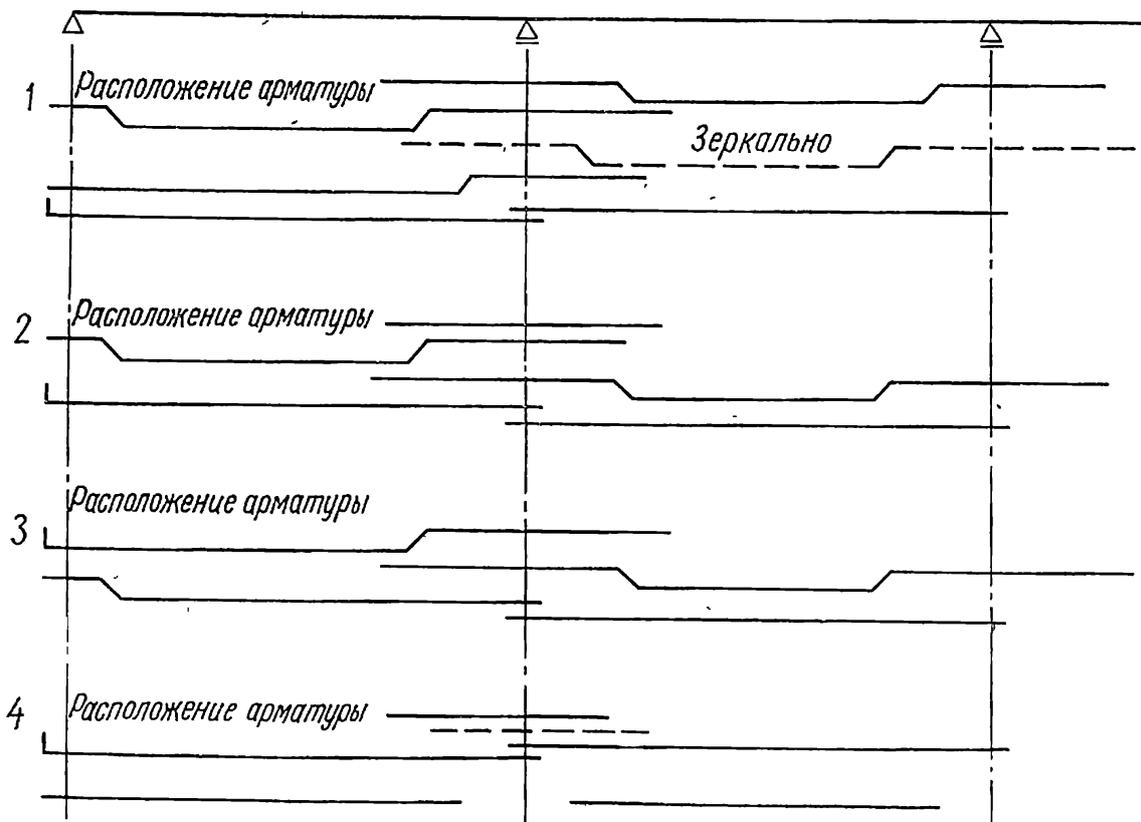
9. Возможные варианты раскладки арматуры у неразрезных плит
